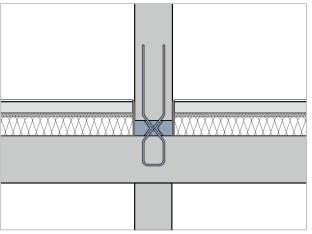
Schöck Sconnex® type W pour mur intérieur et isolation sur la dalle
